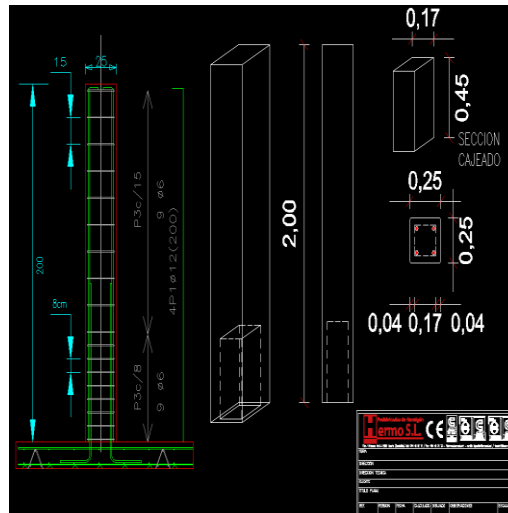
planos de pilares (arriba), armadura pasiva en molde encofrado (derecha b)
